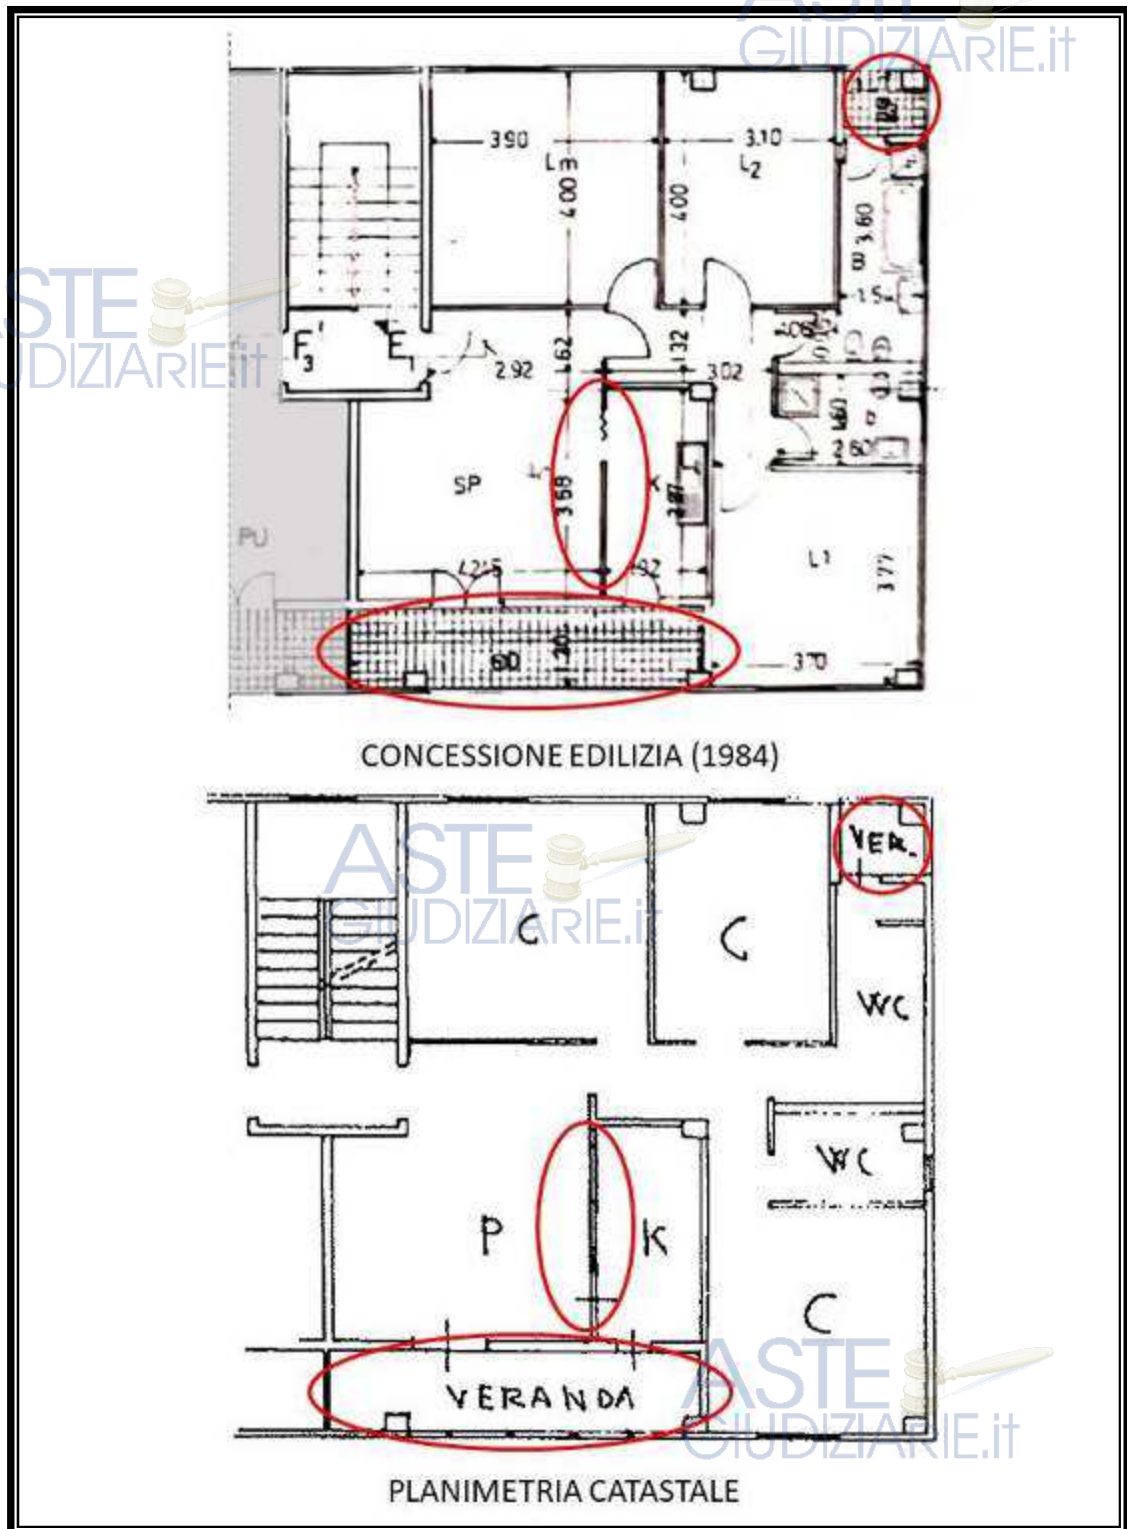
Confronto tra Planimetria catastale e la Concessione (1984)
